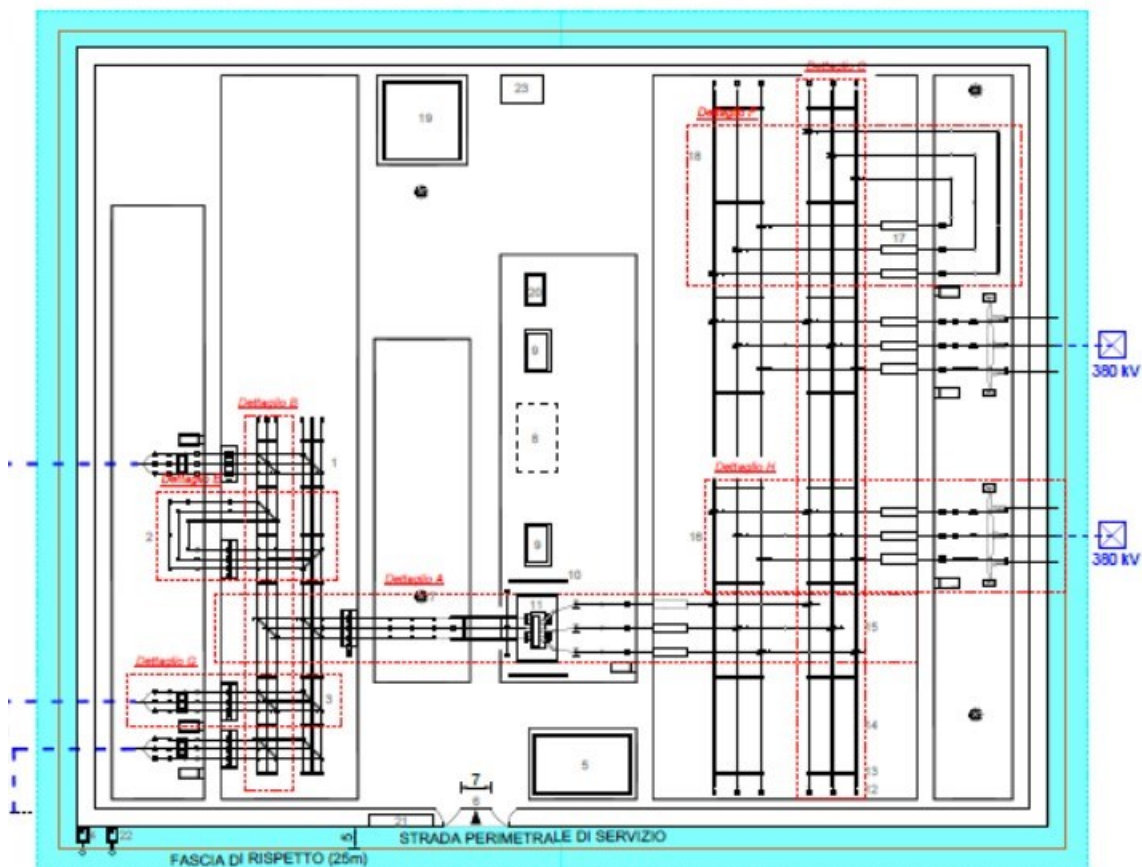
pianta della Stazione Elettrica Terna 380/132 kV
